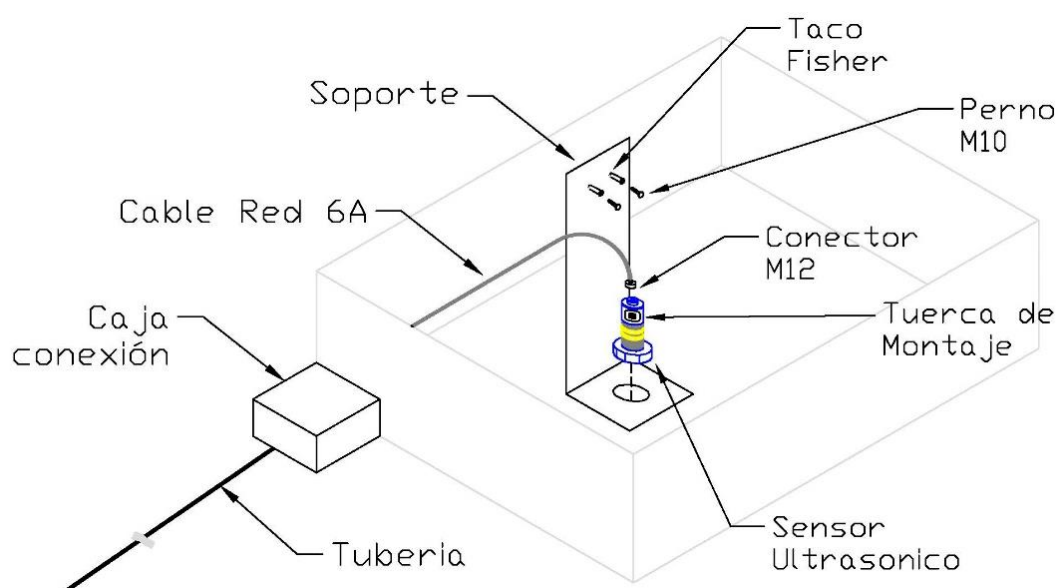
Montaje del sensor dentro del tanque de almacenamiento
